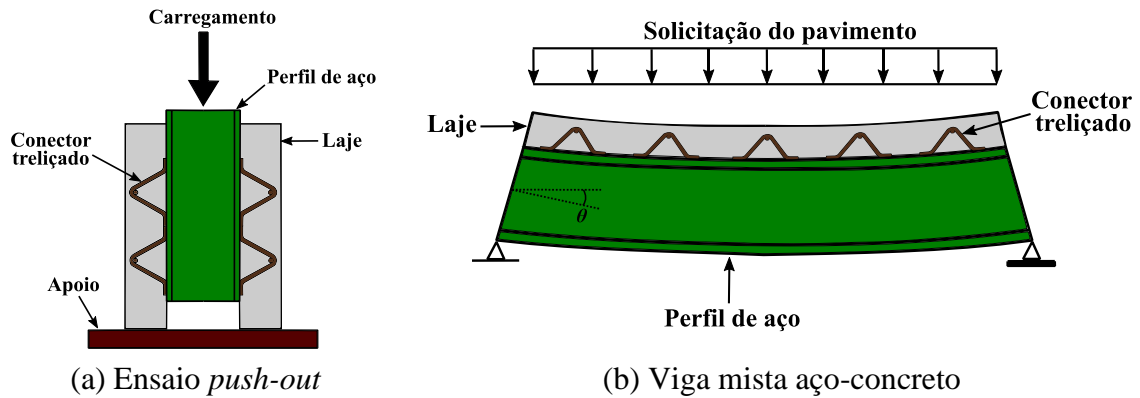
Comparação entre os fenômenos presentes no ensaio *push-out* e na viga mista aço-concreto.
